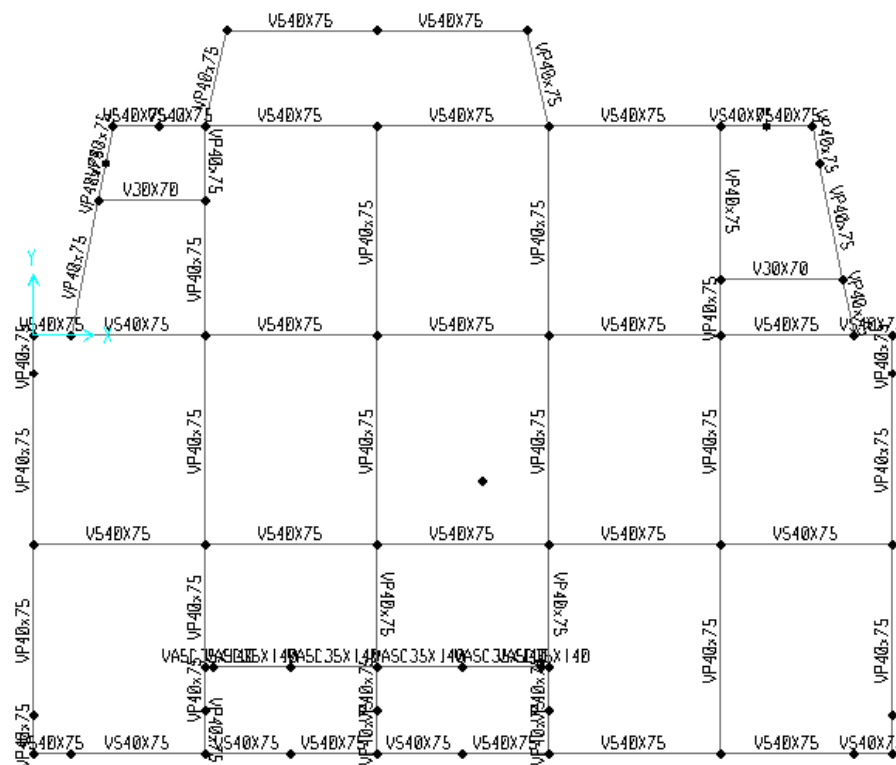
Planta típica pre dimensionado inicial de la estructura<sup>43</sup>.
